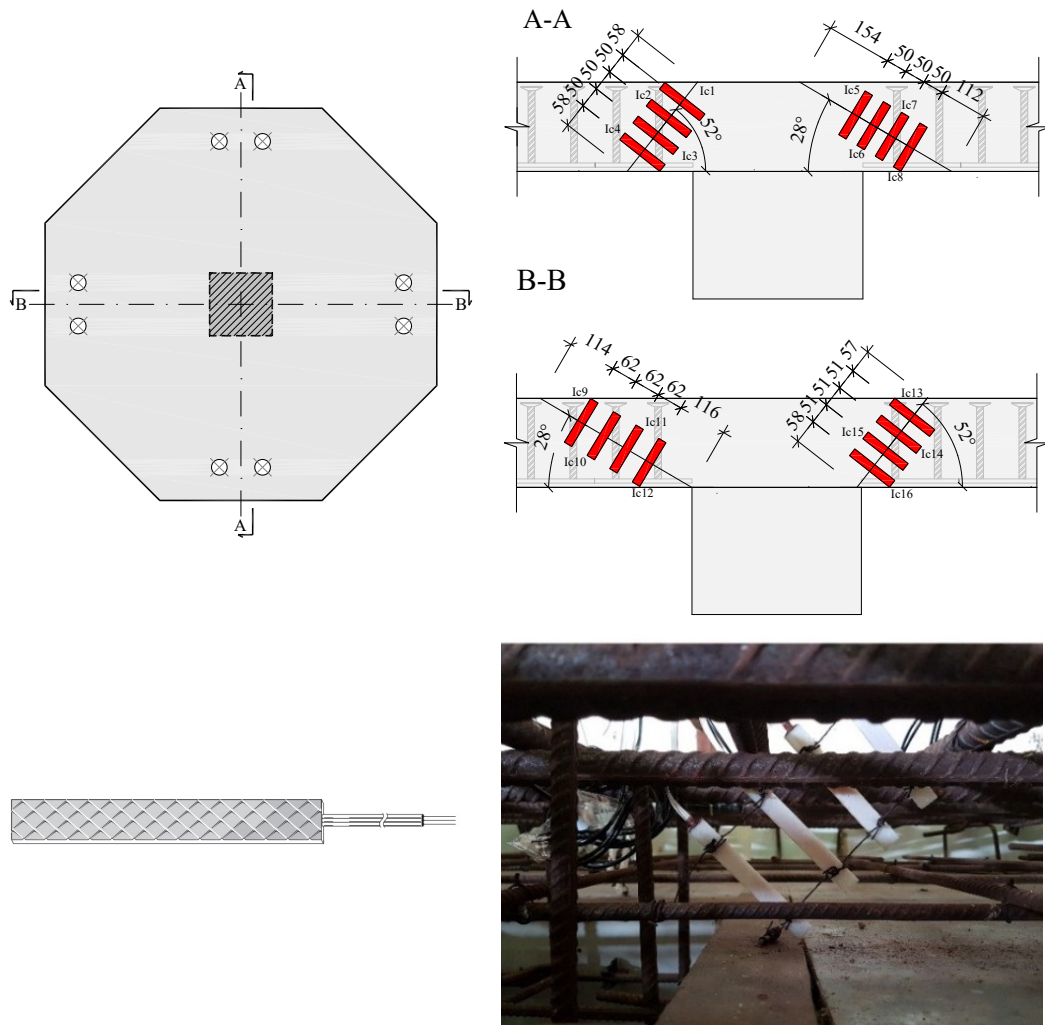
Instrumentação internas ao concreto das lajes S0, SR1 e SR2.
